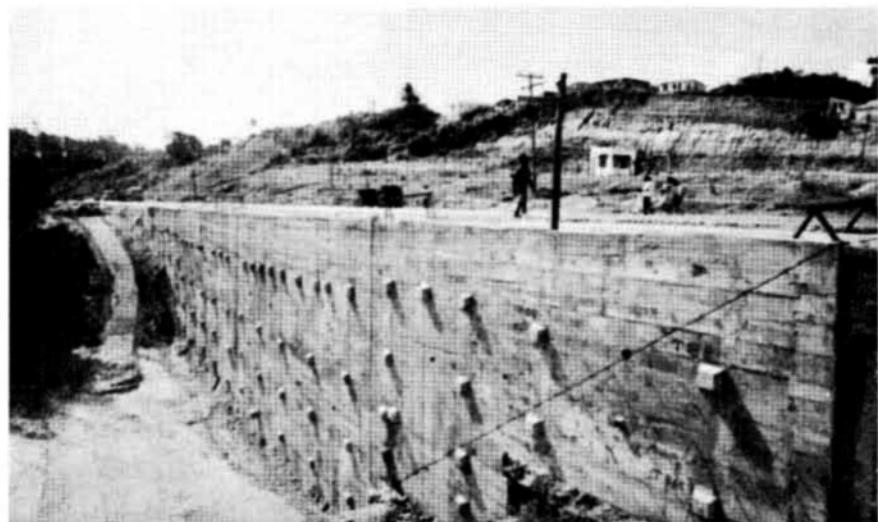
Estabilização em cortina ancorada de grande altura em zona de aterro e massapê – Rodovia 324, perto de Salvador – DNER
